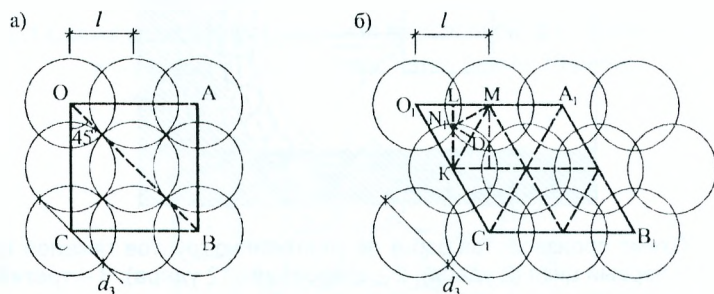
Схемы размещения точек уплотнения грунта трамбовками:
